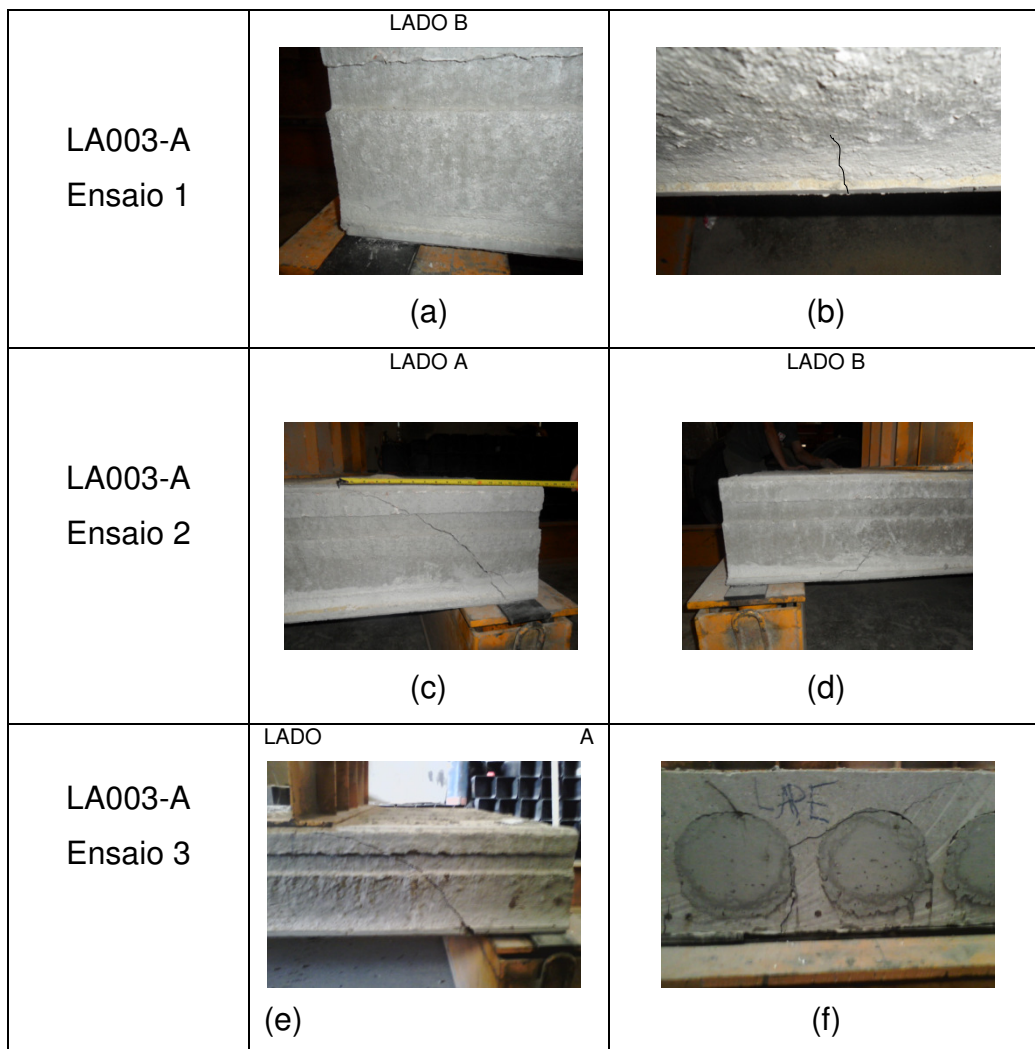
FISSURAS DAS LAJES LA003-A APÓS OS ENSAIOS.
